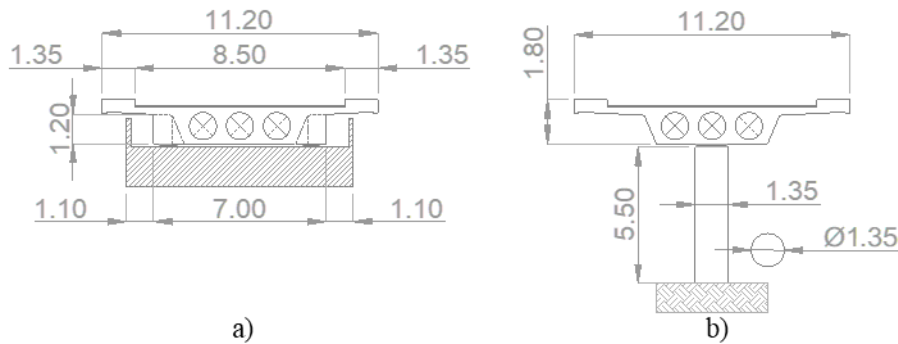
Sección transversal del puente Boedo. (a) En estribo. (b) En la mitad de la luz. Dimensiones en metros.
